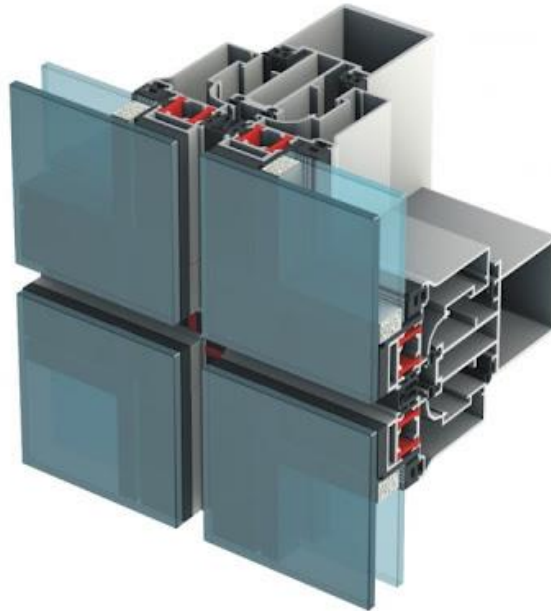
Стійко-ригельна конструкція для кріплення скляних фасадів
